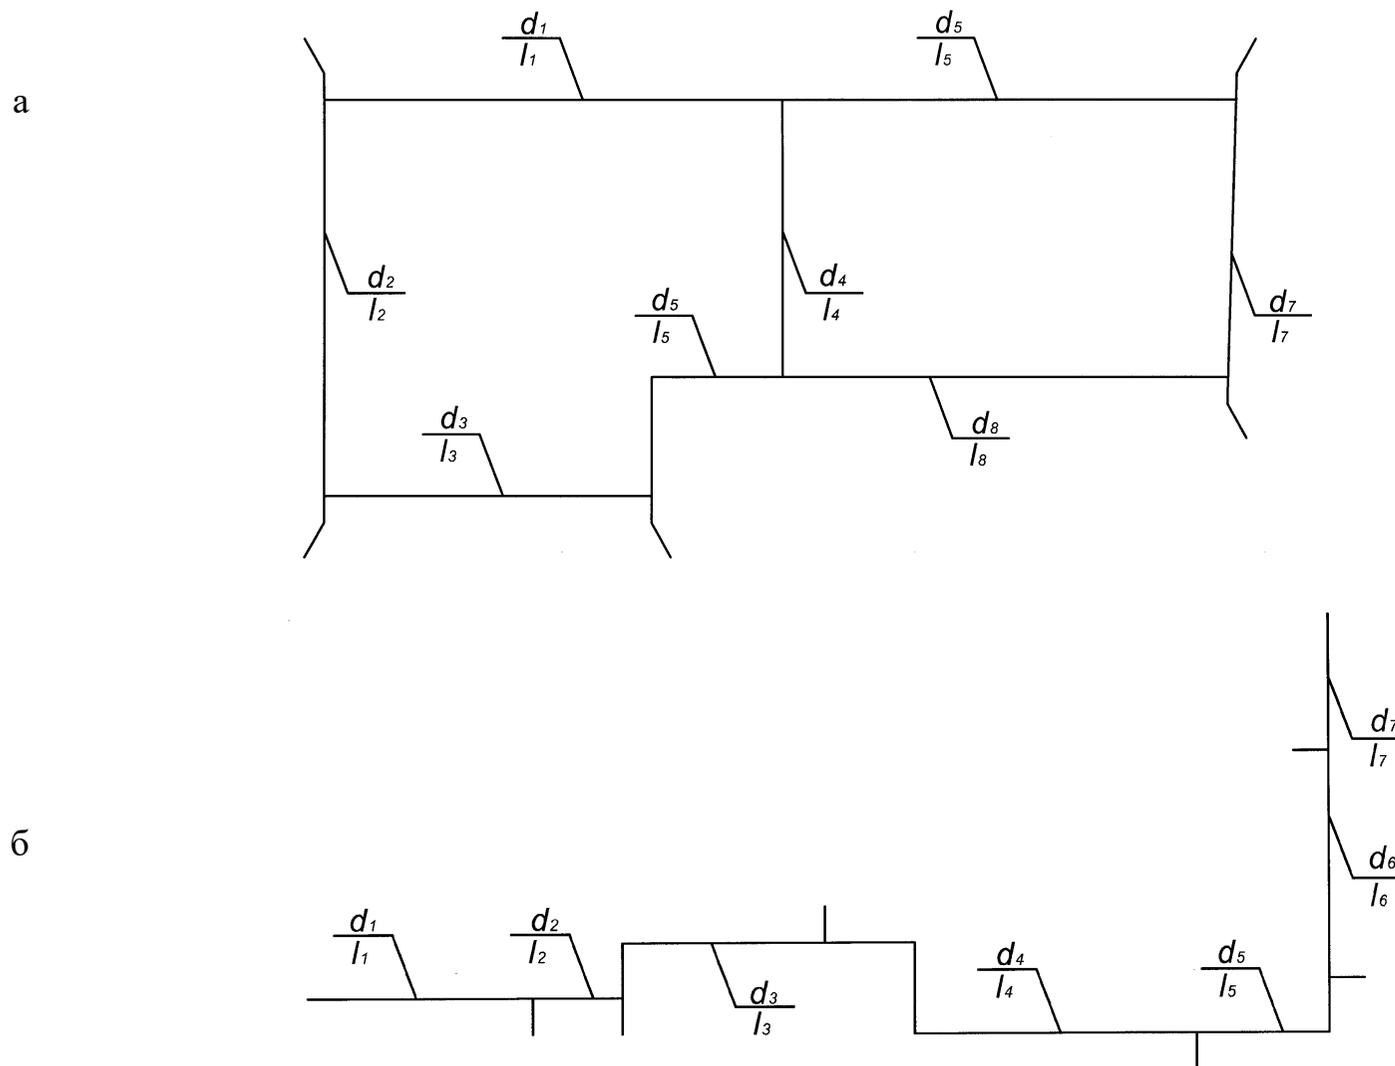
Схемы газовой сети для проектирования организации строительного-монтажных работ
